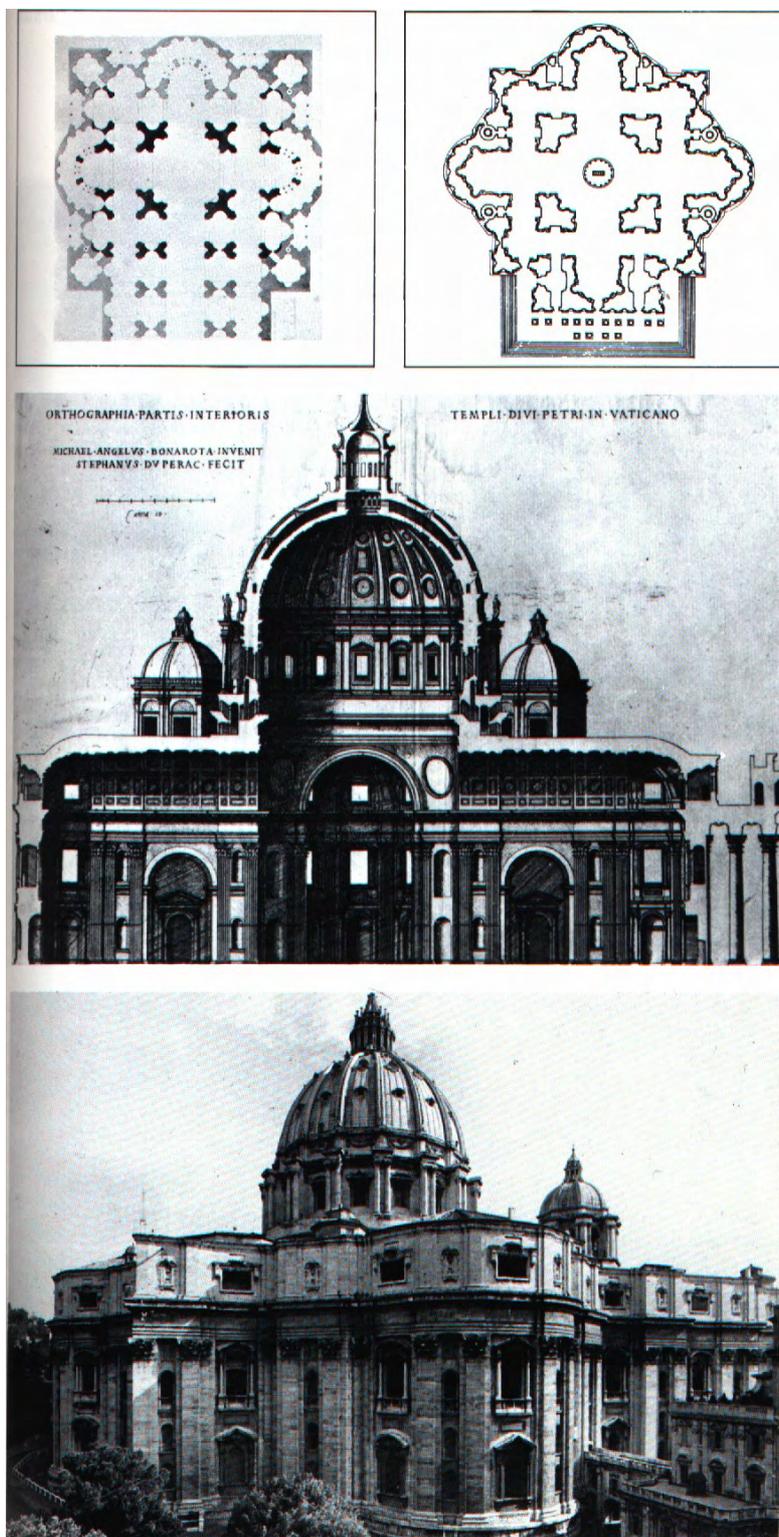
Basílica de San Pietro –Planta, corte e fachada
